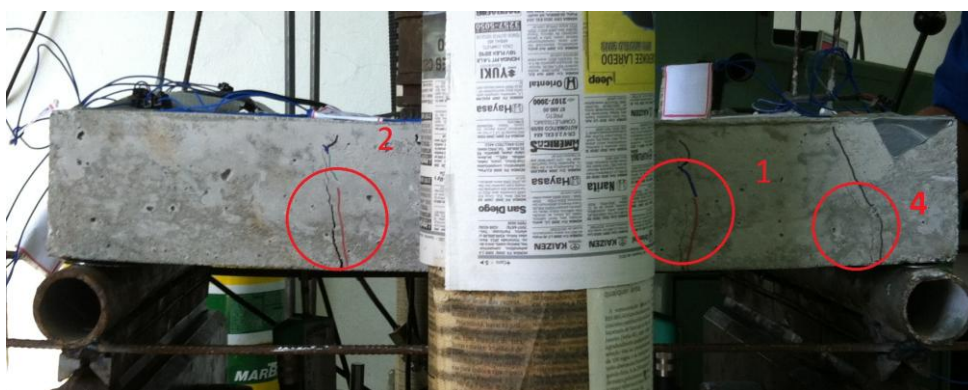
Detalhe do 1º, 2º e 4º tipos de fissuras de PL-01
